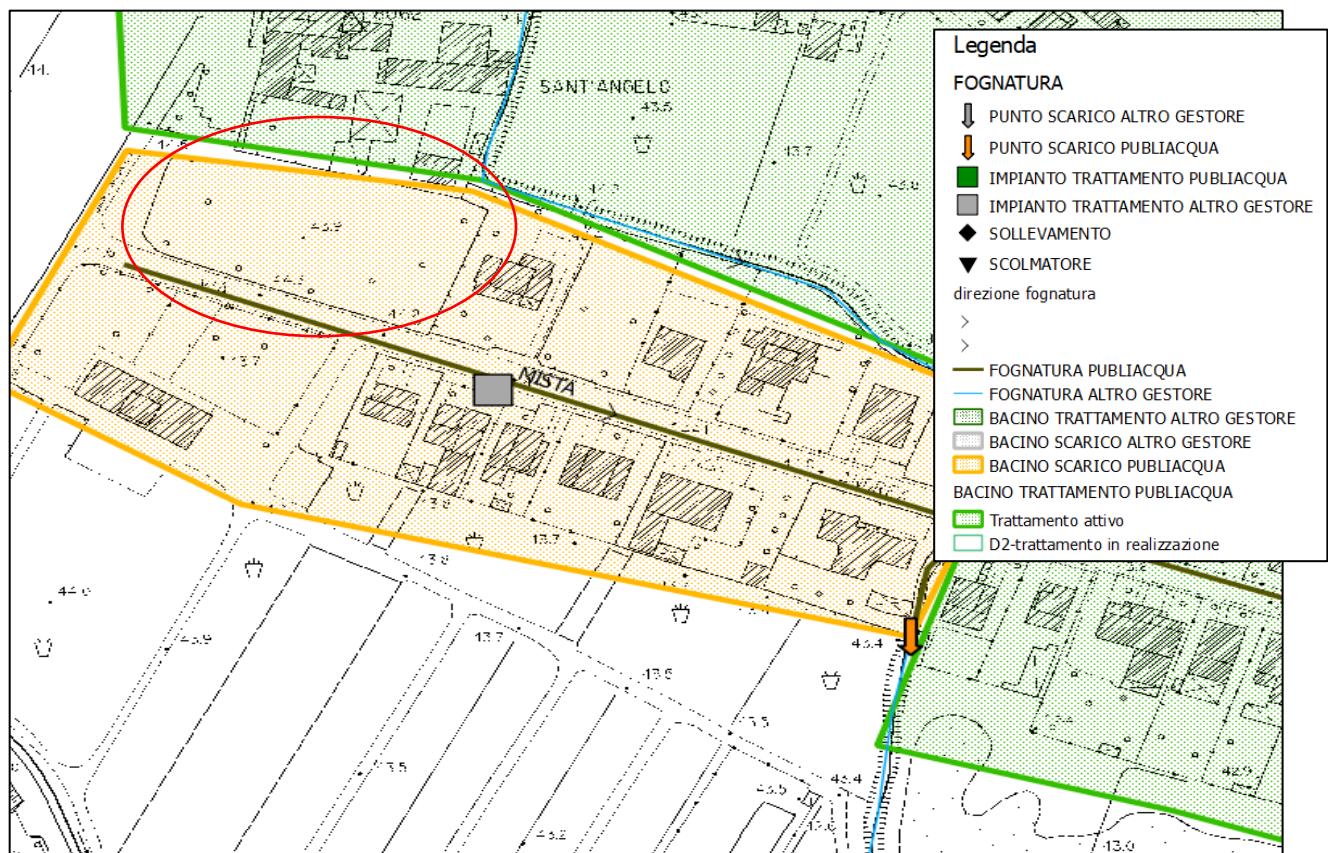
Estratto planimetria rete acque reflue Publìacqua
